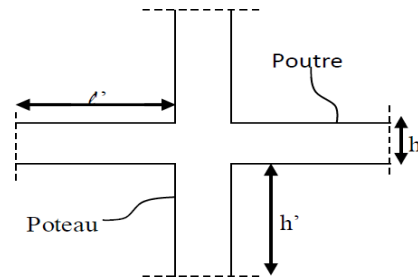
Zone nodale (nœud poutre-poteaux)
